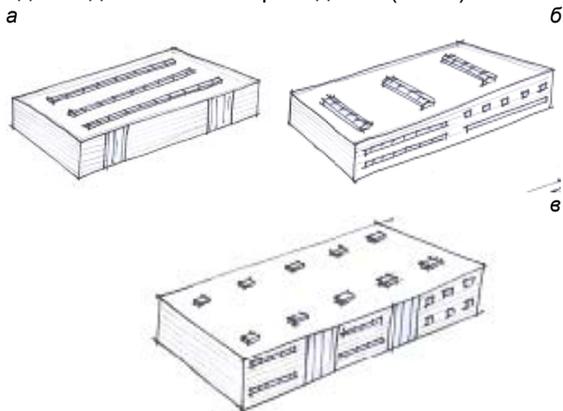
а – ленточные фонари верхнего освещения с продольным расположением и витражами наружной стены; б – ленточные фонари верхнего освещения с поперечным расположением и ленточное остекление, окна; в – совмещенное устройство
